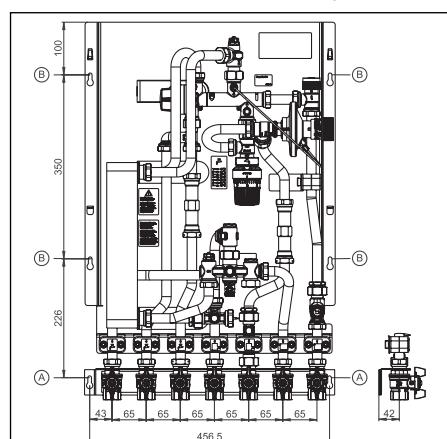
Anschlussschema Kugelhahnanschlussleiste 1341080
